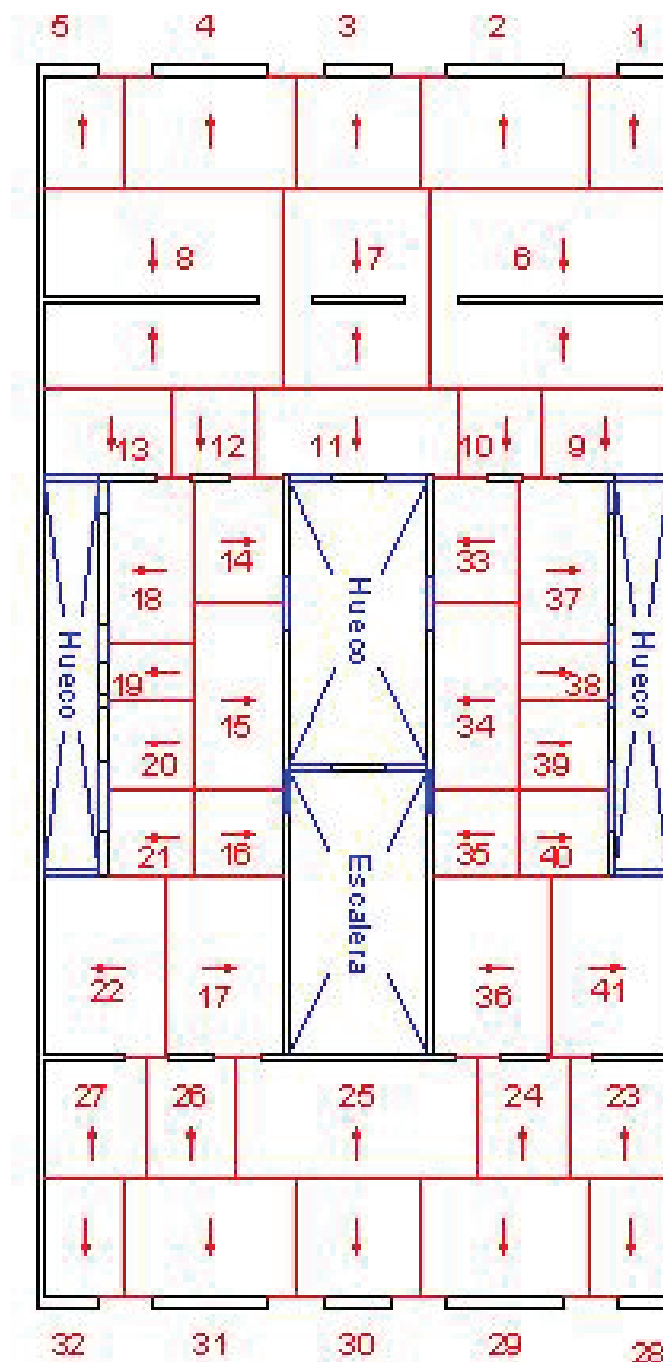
Plano de planta tipo con áreas de carga y pared sobre la que apoyan.
